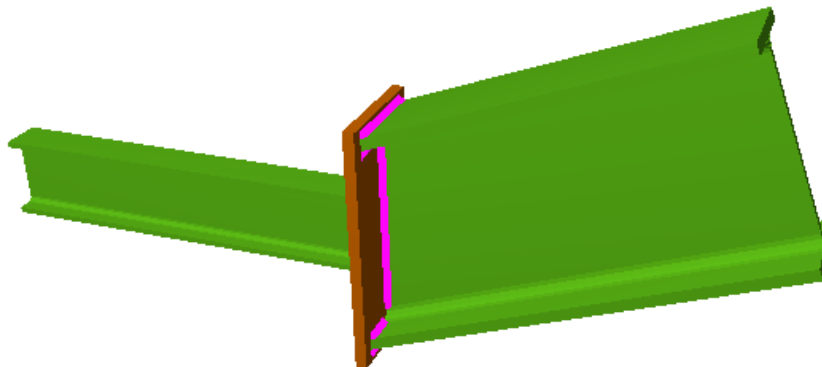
Vista 3D soldadura efectuada
